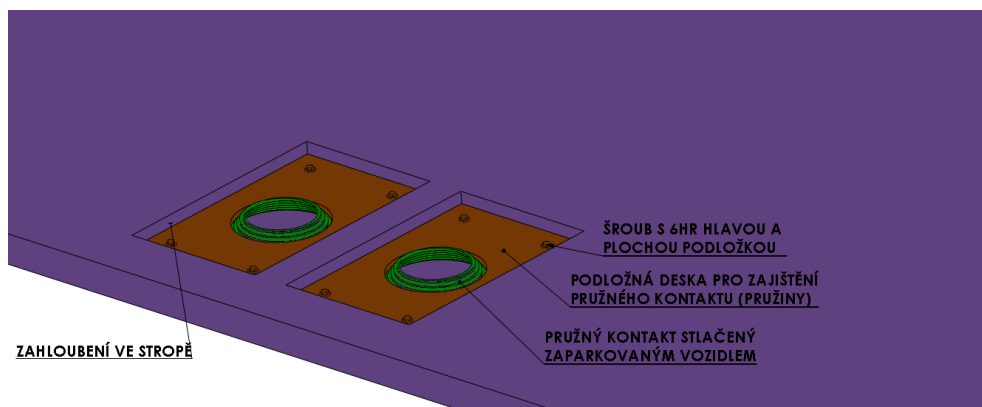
Definitivní stavební struktura - rozložení zahloubení pro kola
